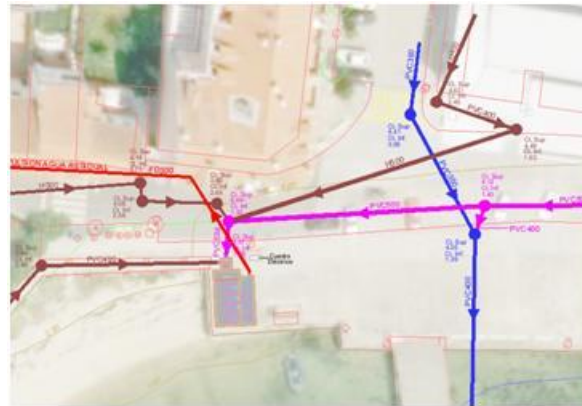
EBAR Concello. Planta general conexiones hidráulicas
